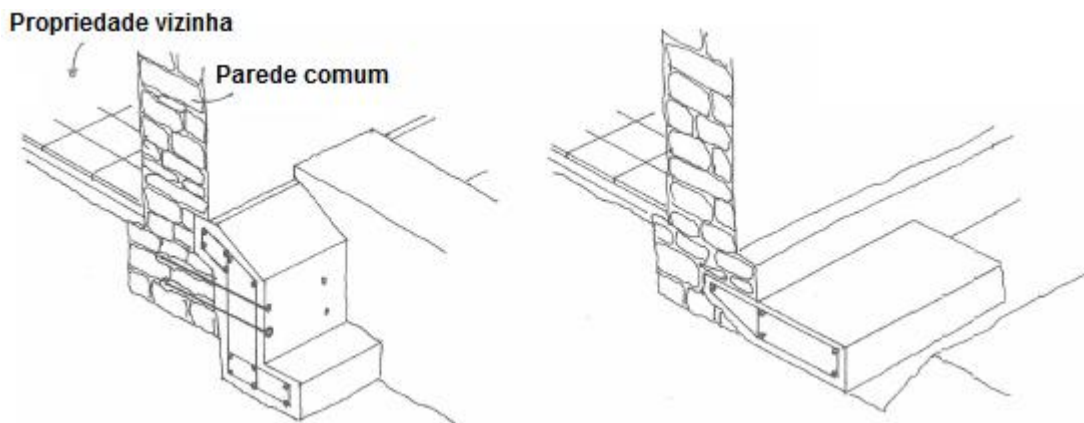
Alargamento executado só de um lado da fundação [55]
